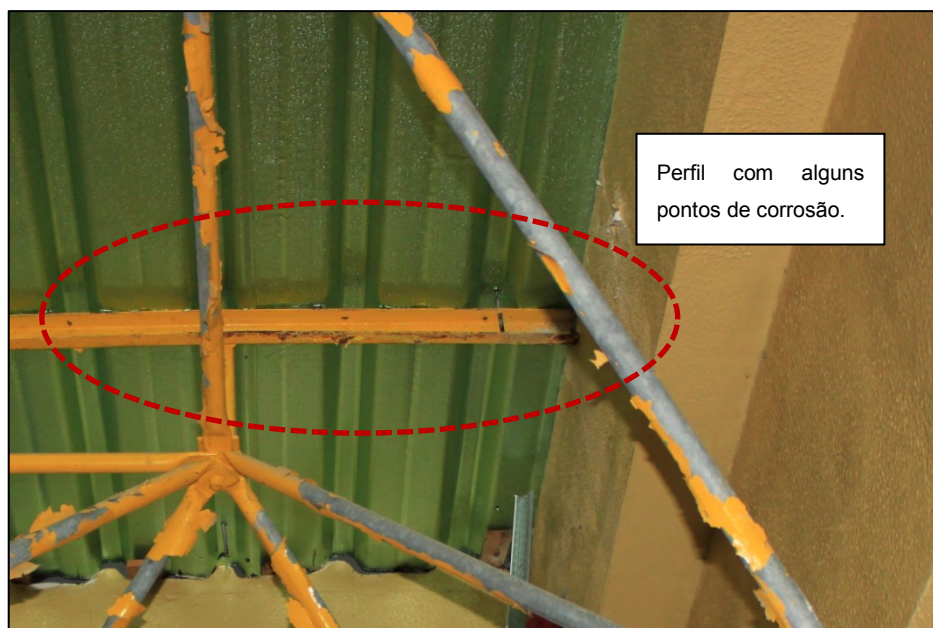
Perfil de ligação da cobertura à estrutura espacial com princípio de corrosão, em zona de anexo ao pavilhão principal.
